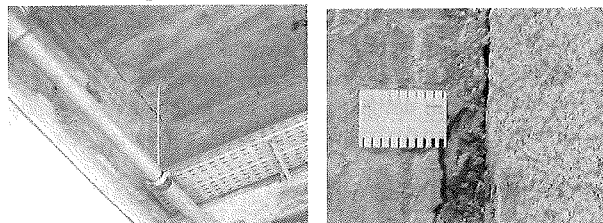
Impalcato del 26° piano: Fessura all'incastro delle travi di estradosso
